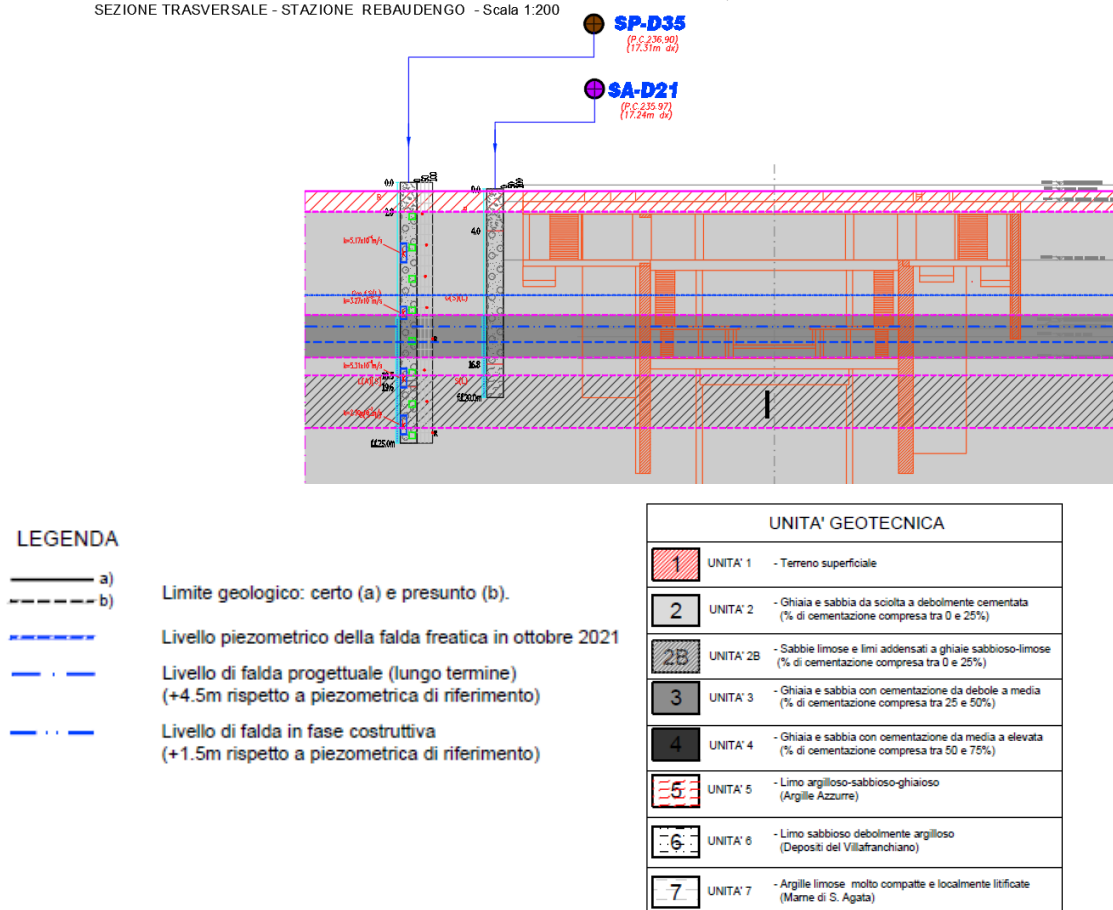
Stralcio stratigrafia stazione Rebaudengo
